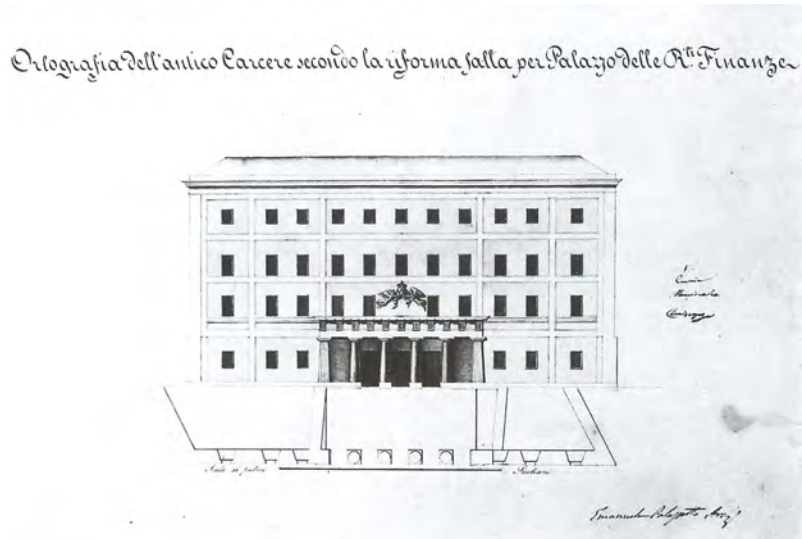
E. Palazzotto, Progetto del palazzo delle Finanze a Palermo, prospetto della facciata principale, 1840 ca.
